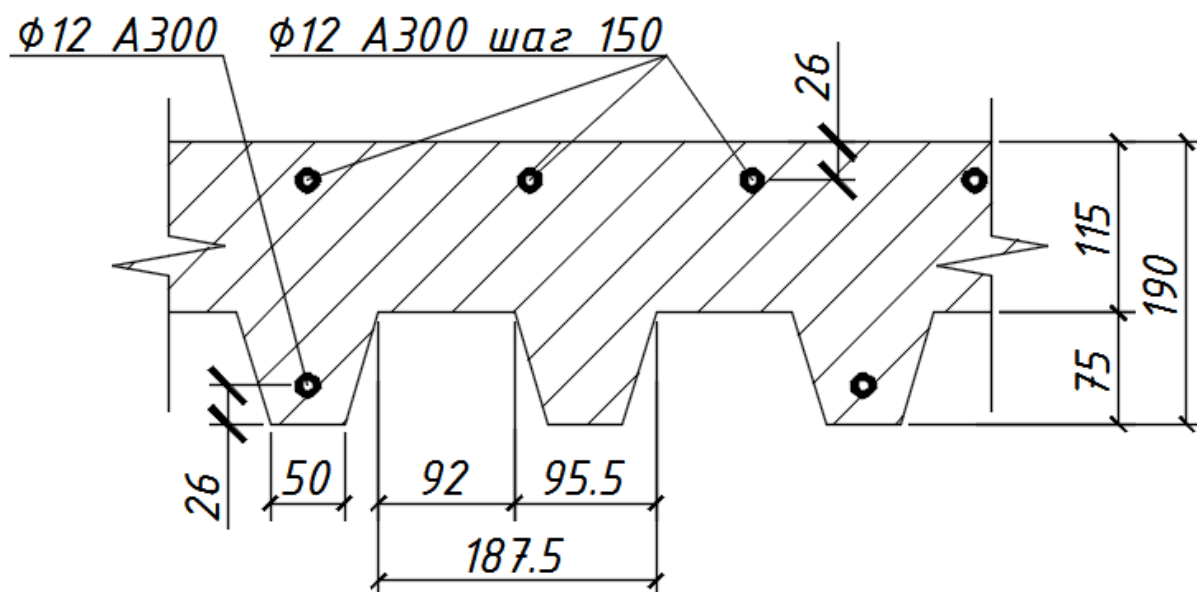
Разрез опорной зоны плиты с расчетным армированием
